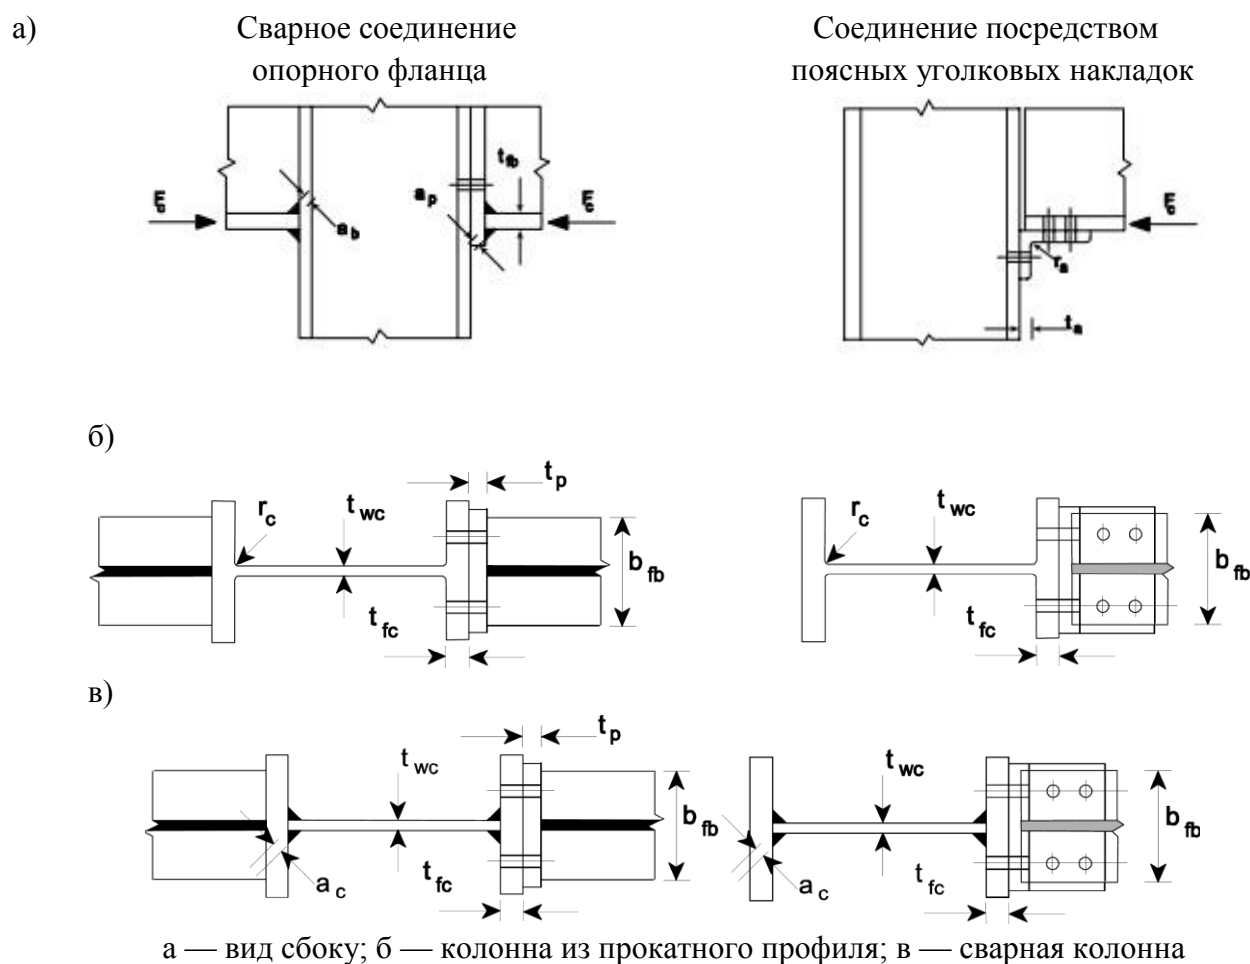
К расчету на поперечное сжатие неусиленной стенки колонны
